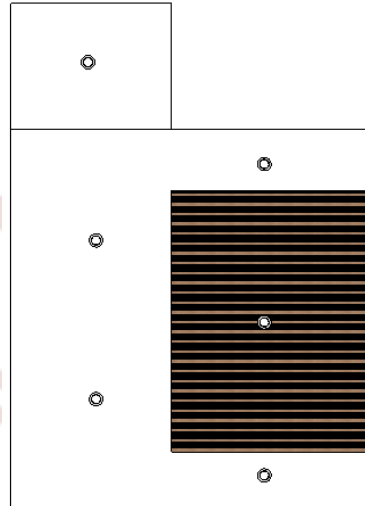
Alternatif 2 Rencana *Ceiling Standard Room
